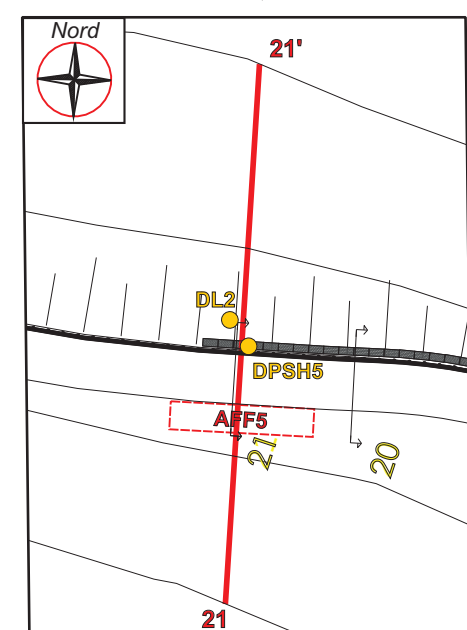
Planimetria del tracciato stradale compreso fra la Sez. 20-20' e Sez. 21-21', in scala 1: 1.000
